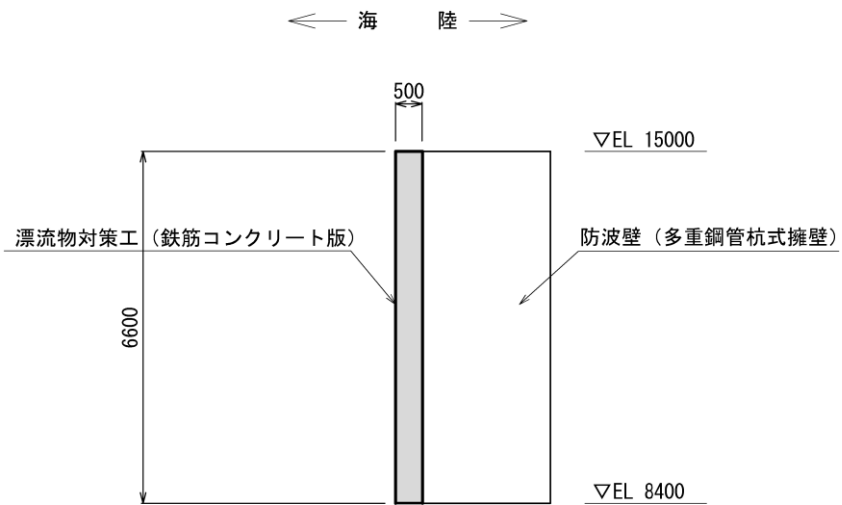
(3) 漂流物対策工（鉄筋コンクリート版）の構造概要図（標準断面図）
